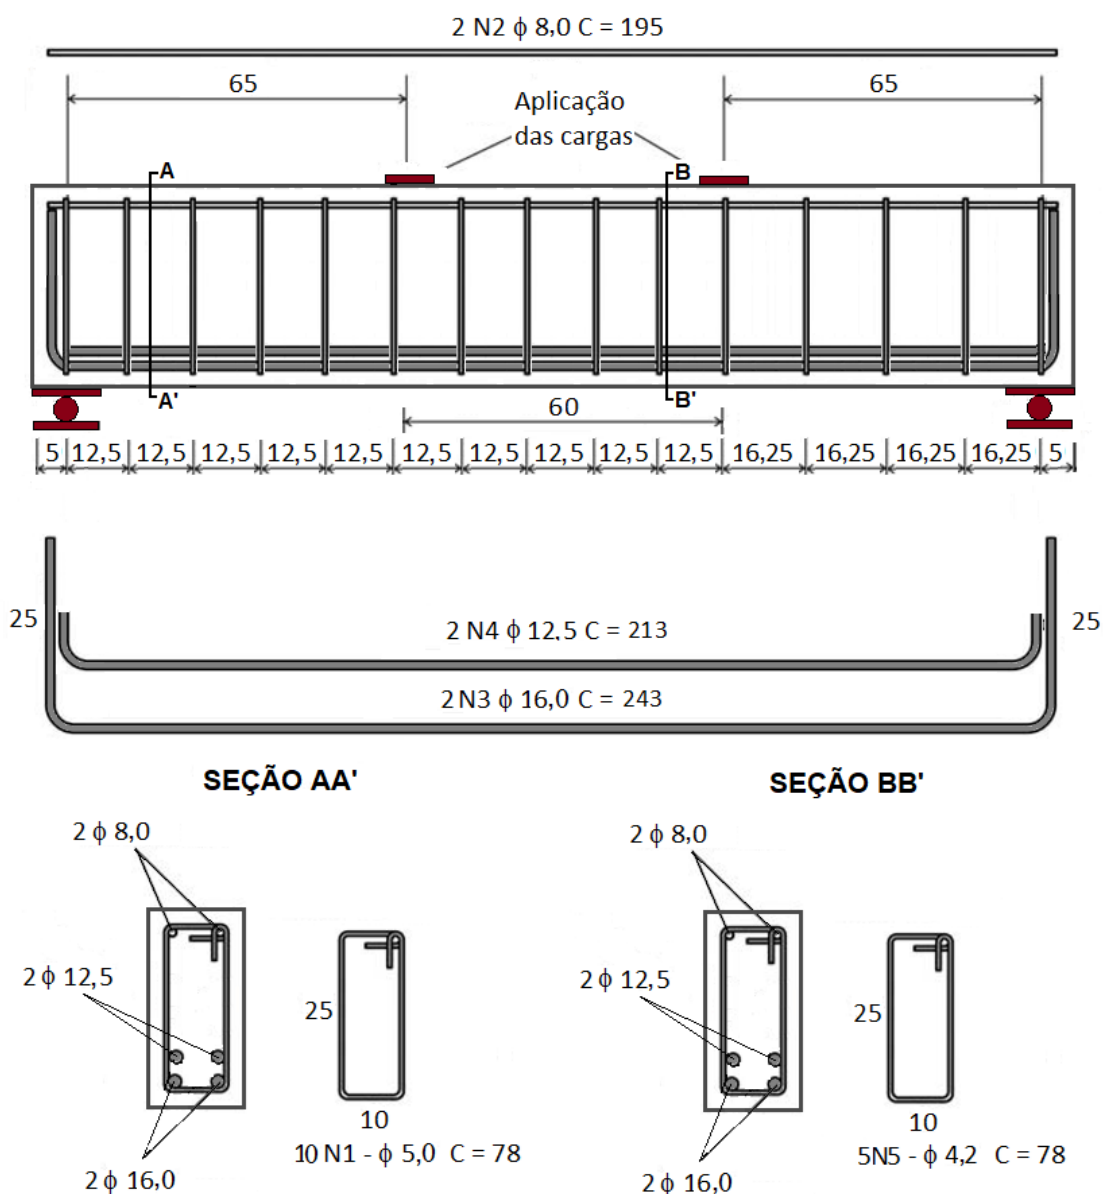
Armaduras das vigas do Tipo 5 (dimensões em centímetros, exceto diâmetros que estão em milímetros).
